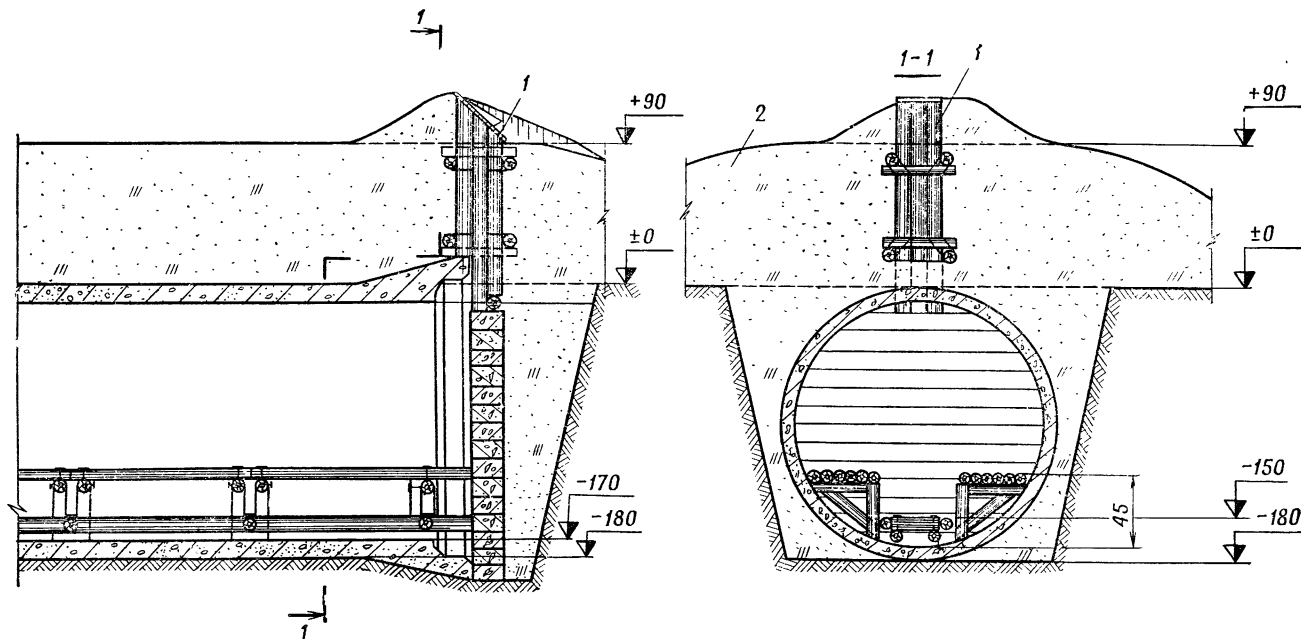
Установка вентиляционного короба в блиндаже из железобетонной трубы:
